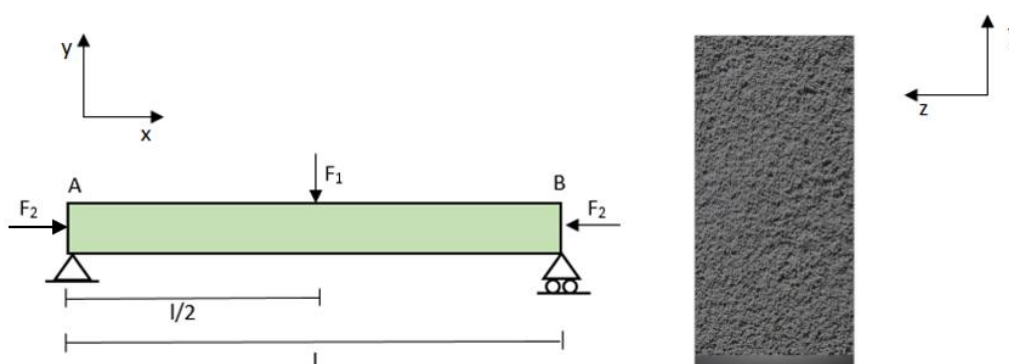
Viga de hormigón con refuerzo de acero sometida a flexión compuesta recta, sección transversal y condiciones de contorno.
